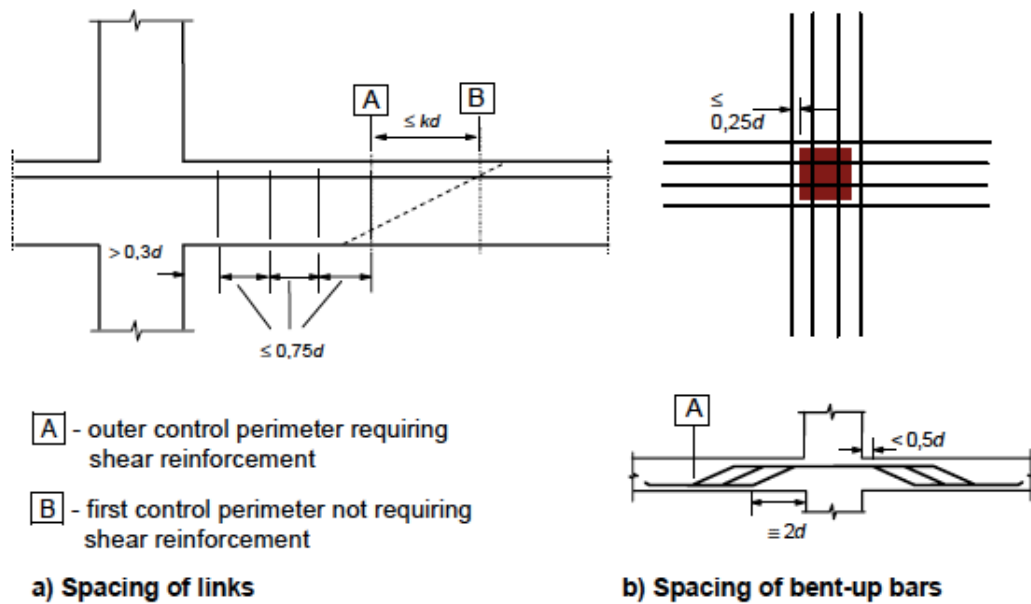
Espacio entre barras de armado de punzonamiento [13]
